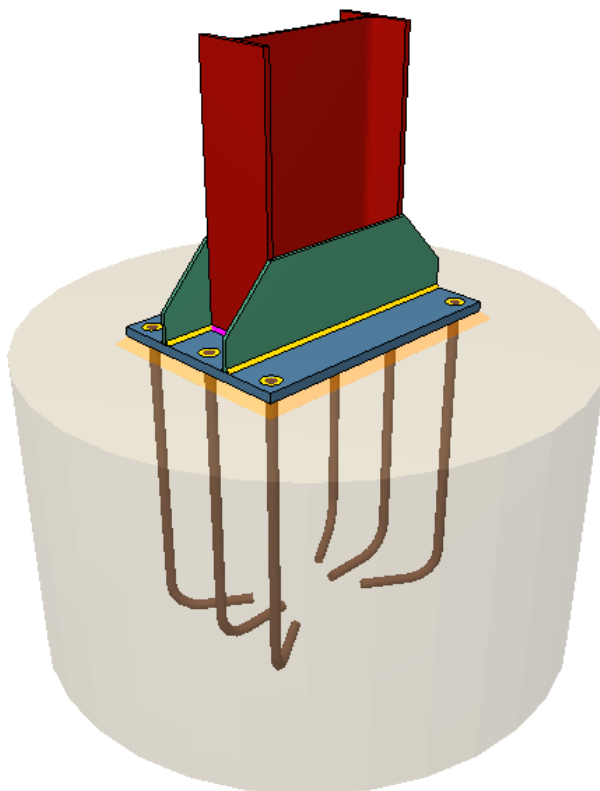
Detalle de la placa de anclaje para los pilares IPE 400.
